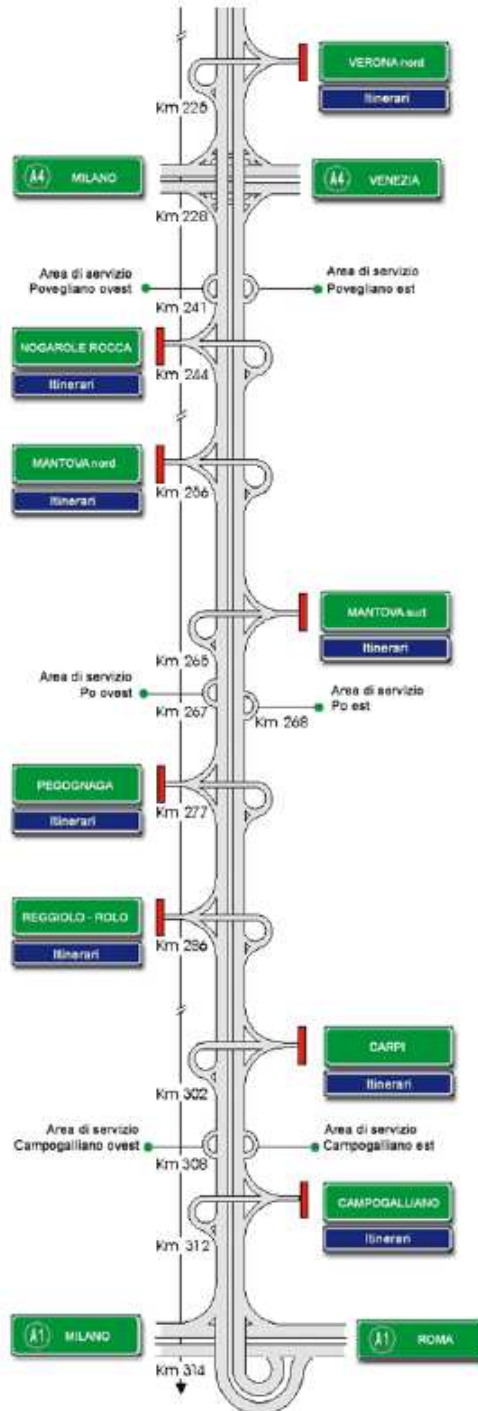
Schema tratto autostradale oggetto dell'intervento
